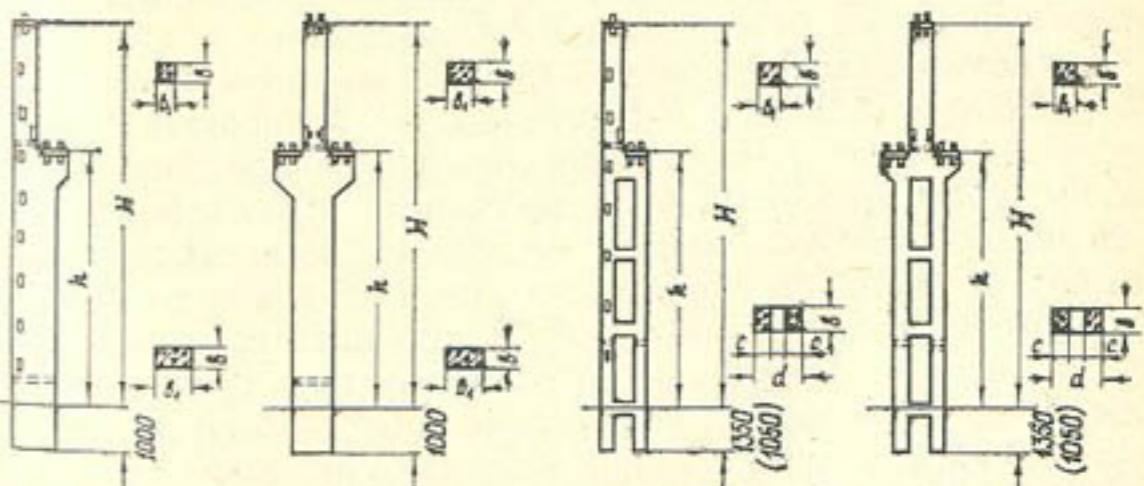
Колонны для промышленных зданий без мостовых кранов (а) и с мостовыми кранами (б).
